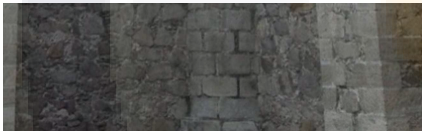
Sistemas constructivos en muros de carga de la mampostería del Templo de San Antonio. (Adaptado de Navarro, 2013).
